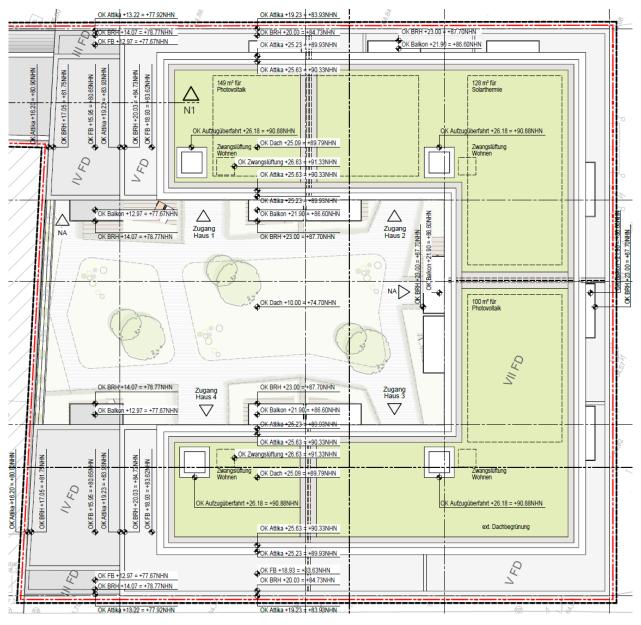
Ausschnitt aus dem Lageplan des Bauvorhabens in Siegburg mit Dachgeschossdetails (ohne Maßstab, ungenordet, Quelle: schulte architekten GmbH).
